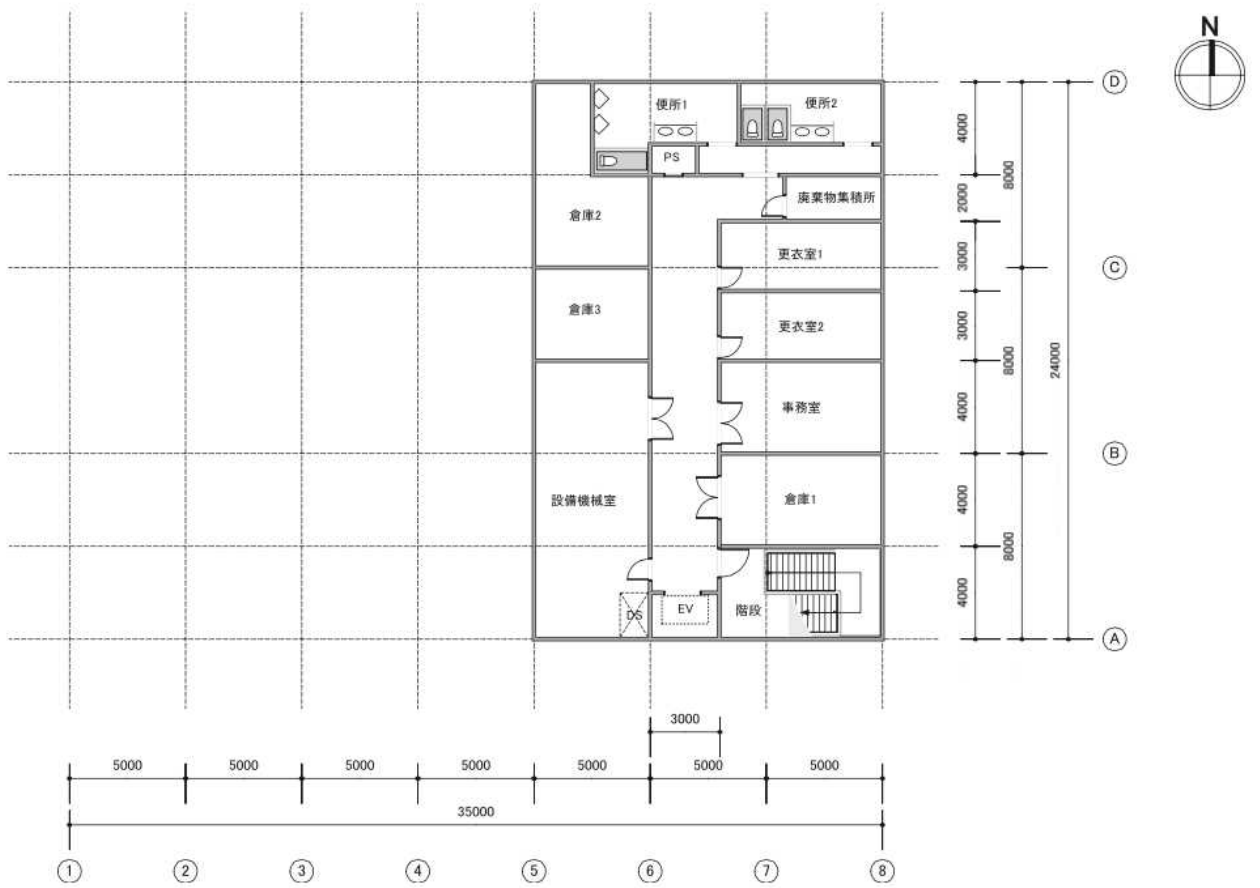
4 モデル建物（大規模物販店舗等） 地下1階平面図
